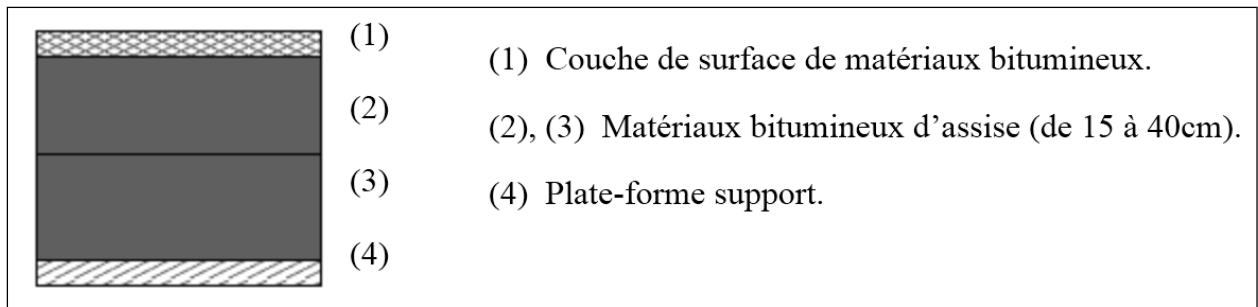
Structure d'une chaussée bitumineuse épaisse (MEZIANI, 2008)
